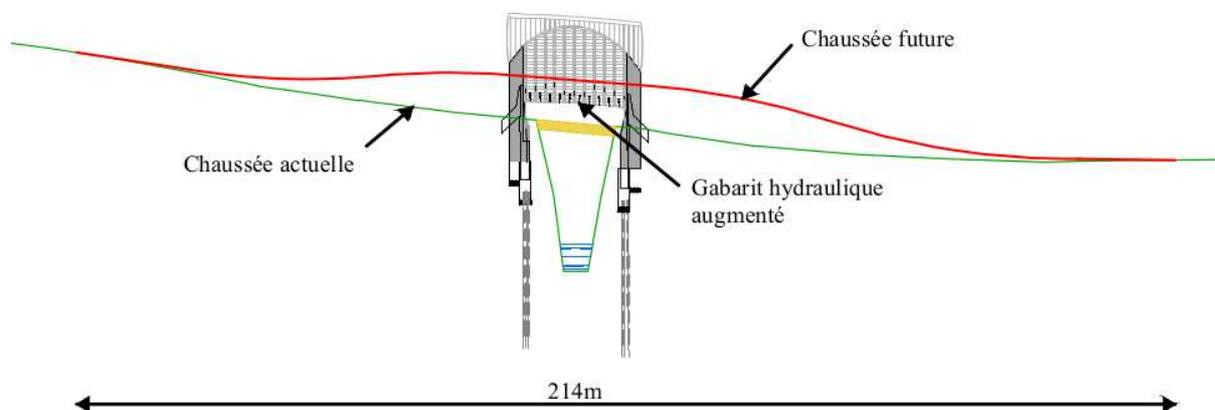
Adaptation du profil en long du pont sur le Mujon avec rehaussement (+ 98 cm) pour gabarit hydraulique (échelle déformée)
